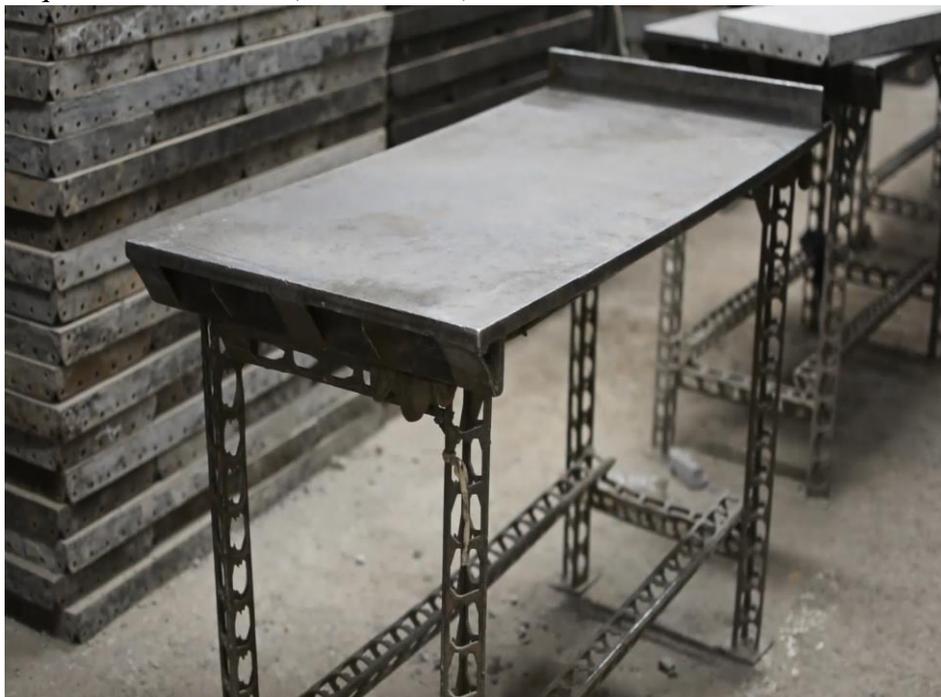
Imagen Video Metalex. Mesón con su plancha de acero.
